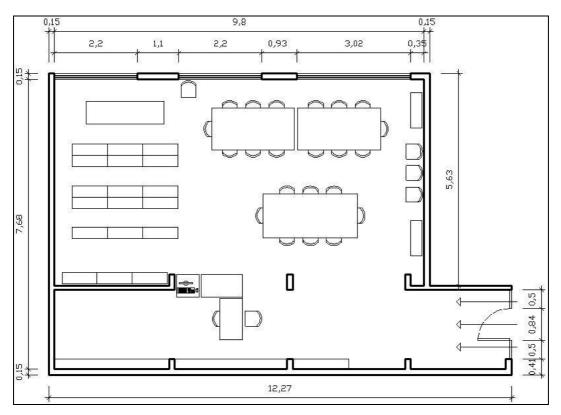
Planta baixa da biblioteca de biologia – UFPB
